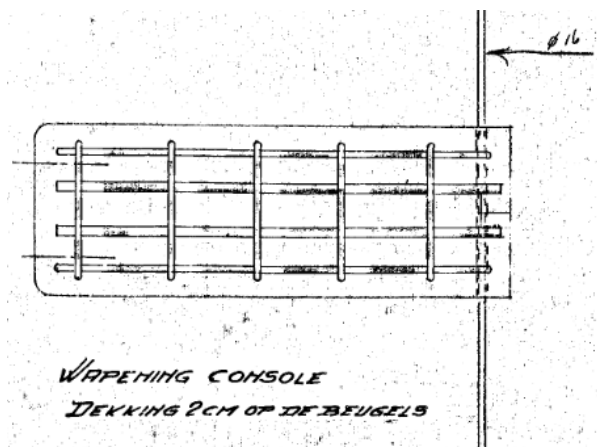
Zij- en kopaanzicht wapening prefab consoles (fragment uit HIC903~1.TIF)
